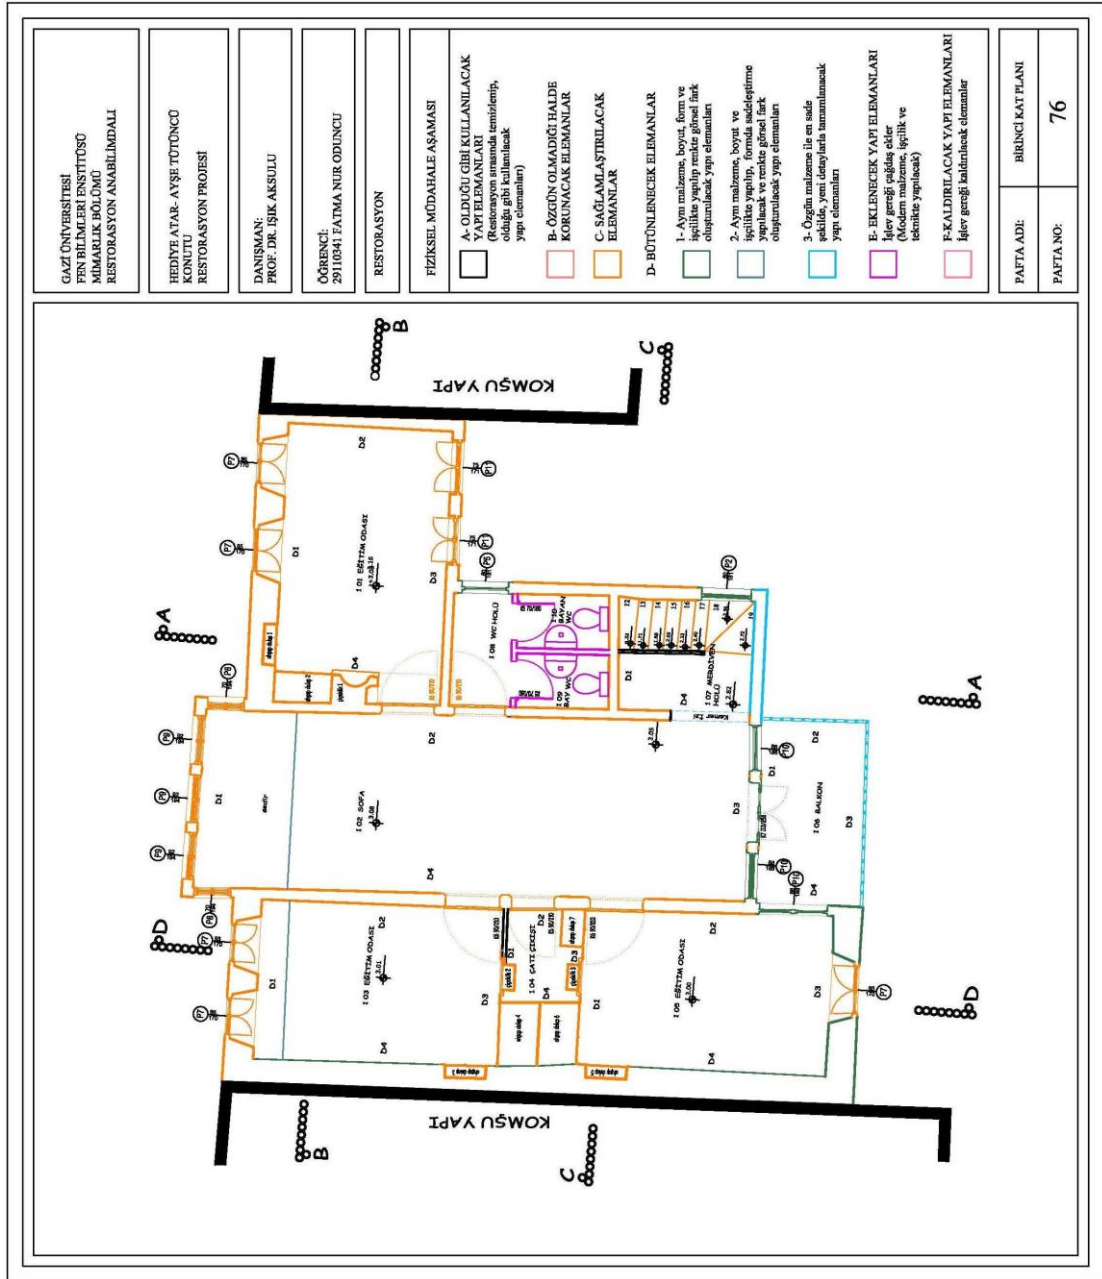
Fiziksel müdahale aşaması vaziyet planı
